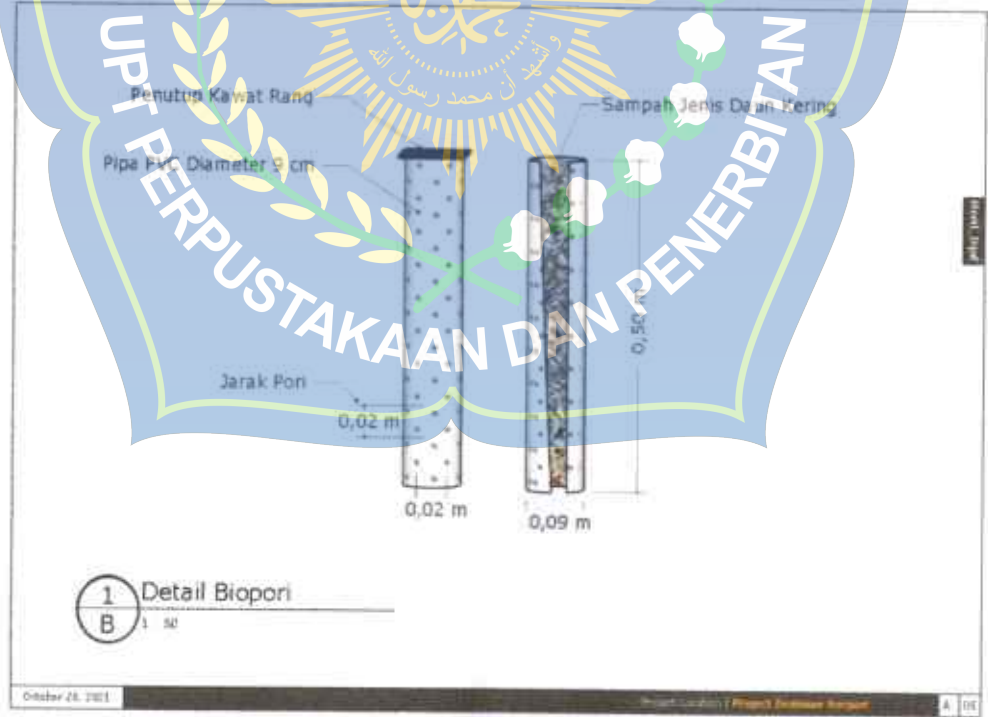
Potongan Memanjang Drainase Berpori Silinder
